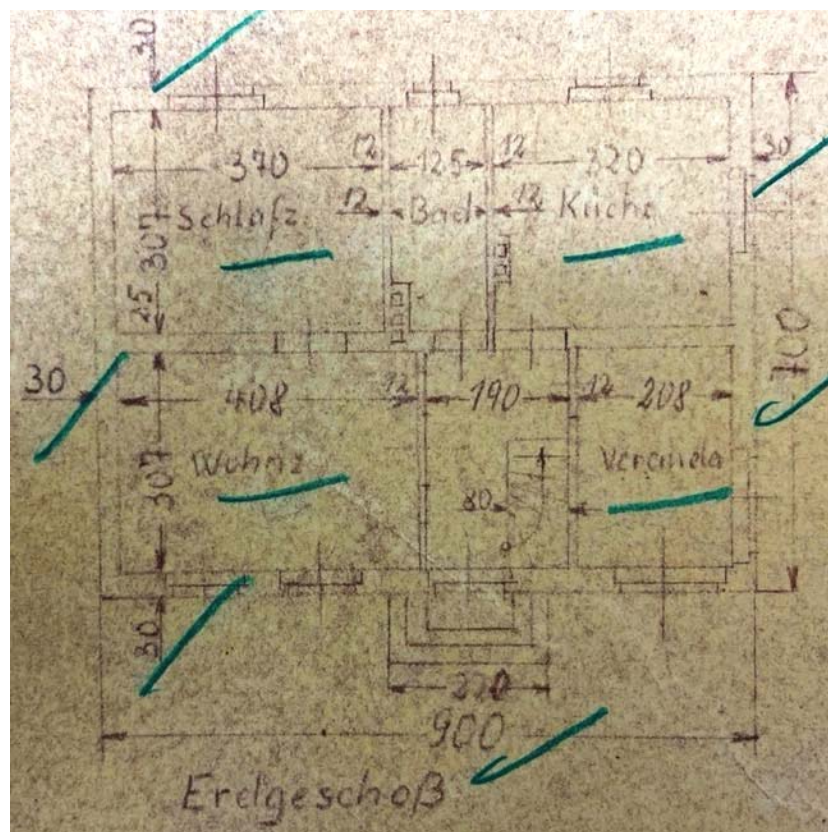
bauzeitlicher Plan – Grundriss Erdgeschoss des Einfamilienhauses
